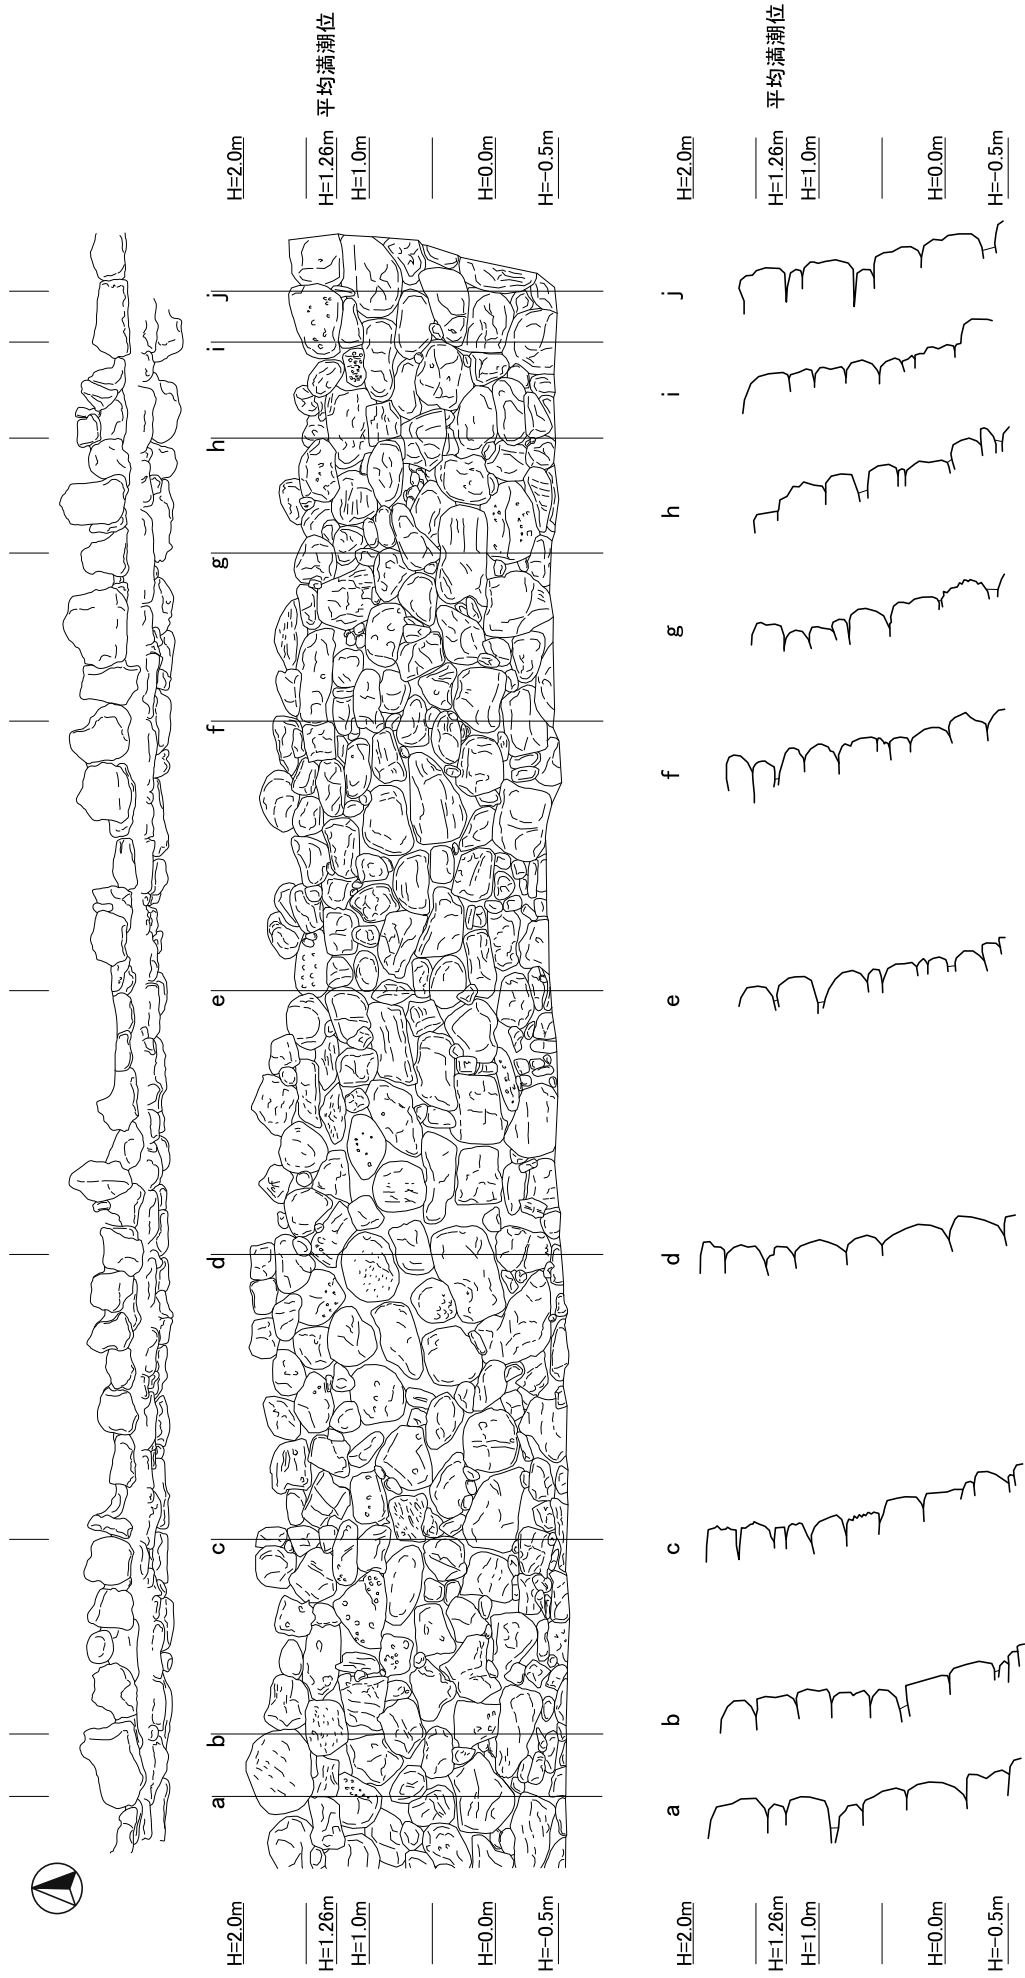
①—3 南側護岸石垣 平面图·立面图·断面图 (S=1/60)
